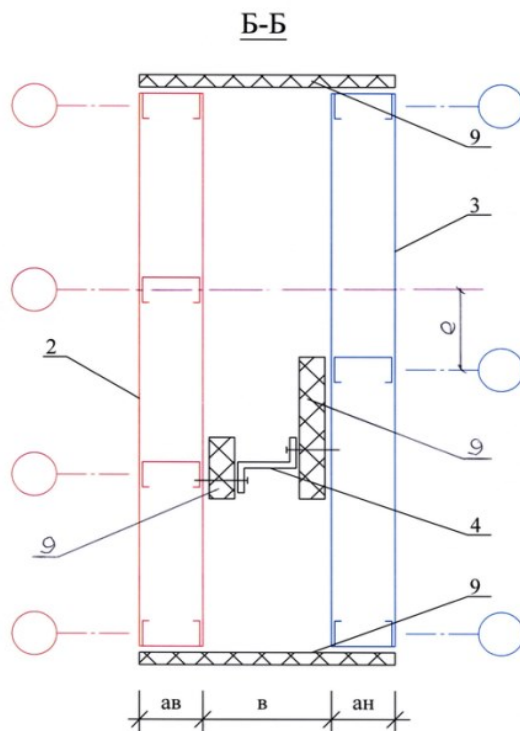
Вид Б на фрагмент сечения наружной стены здания [3] (рис. 4):
